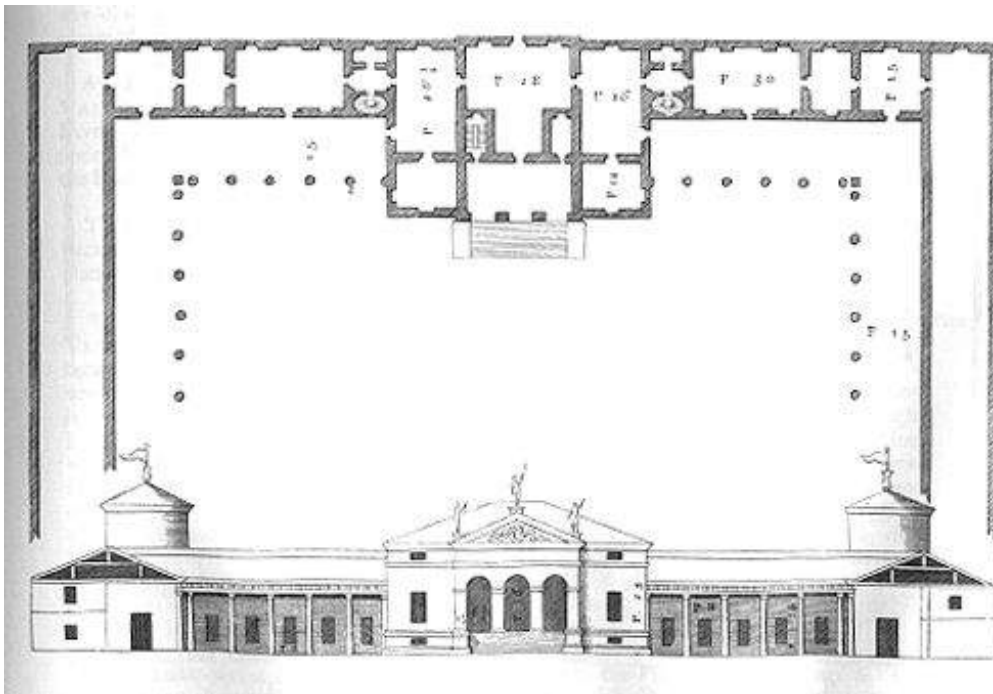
Planta y fachada de la villa Saraceno, según aparece en la primera edición del libro de Palladio, publicada en Venecia en 1570.
